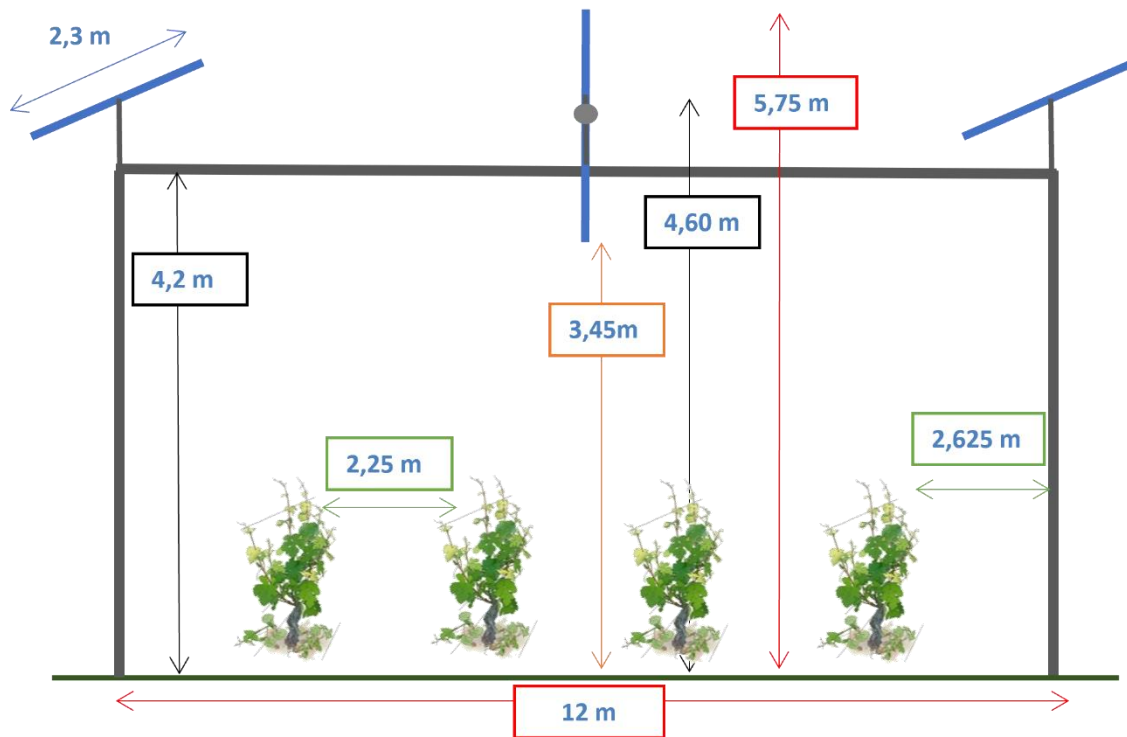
Schéma de la structure (coupe Est-Ouest) (Source : Sun'Agri)
